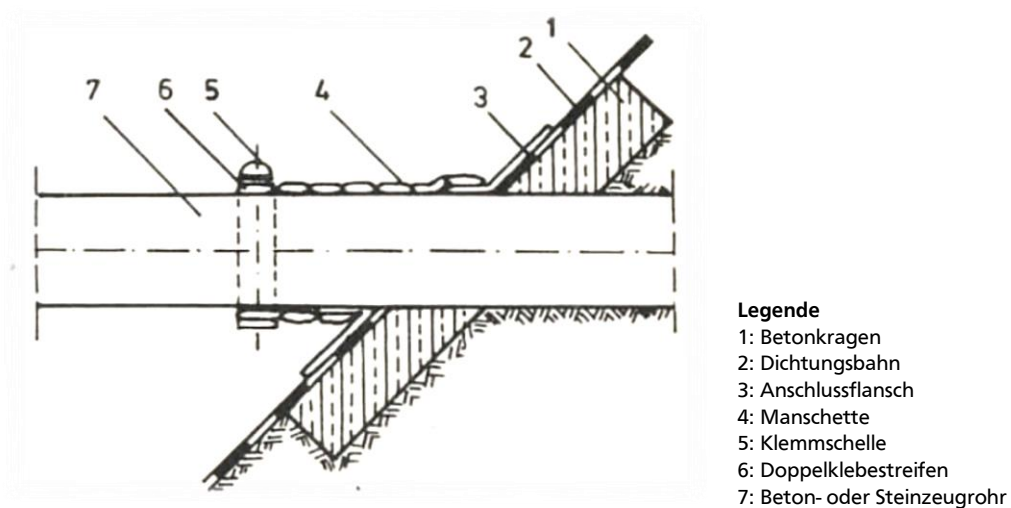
Anschluss einer Dichtungsbahn an eine Leitung mittels einer Klemmverbindung⁶⁸
